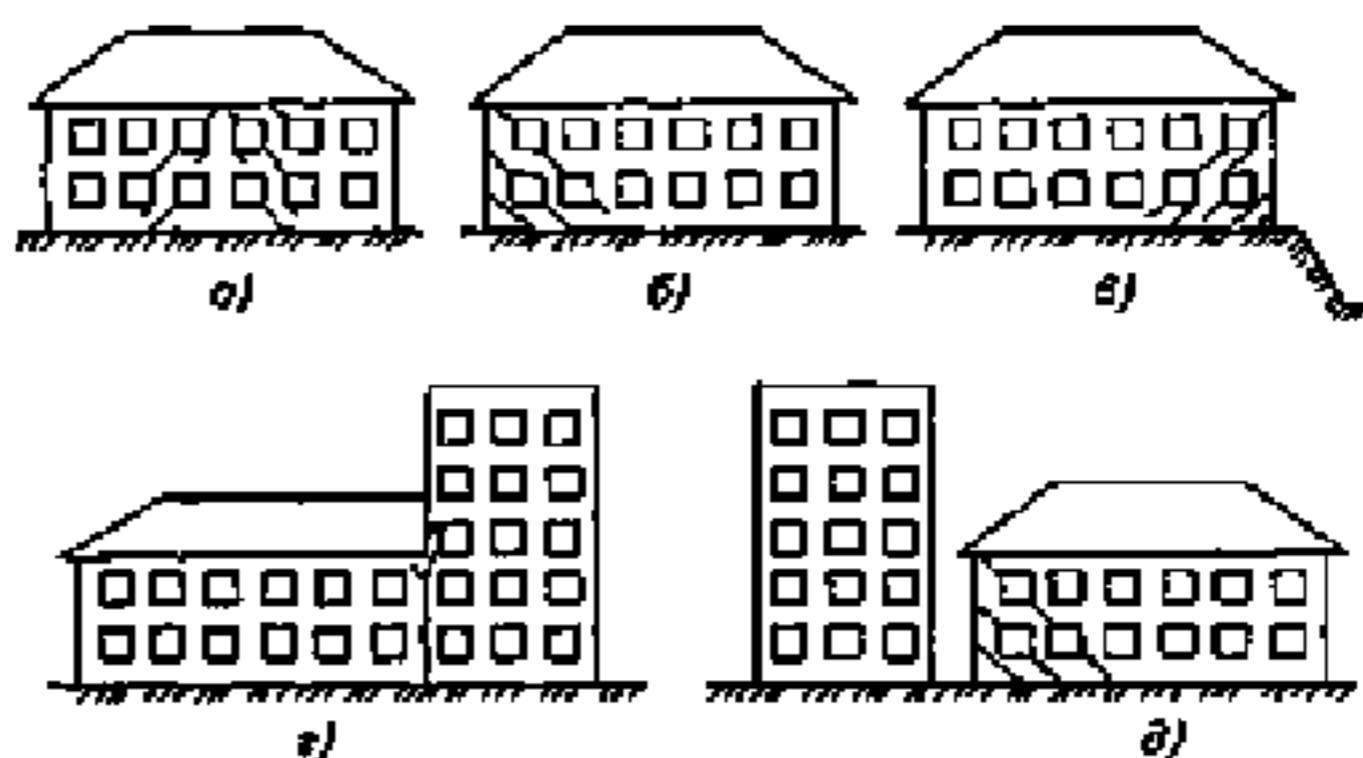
Причины образования трещин в несущих стенах из-за неудовлетворительного состояния оснований и фундаментов:
